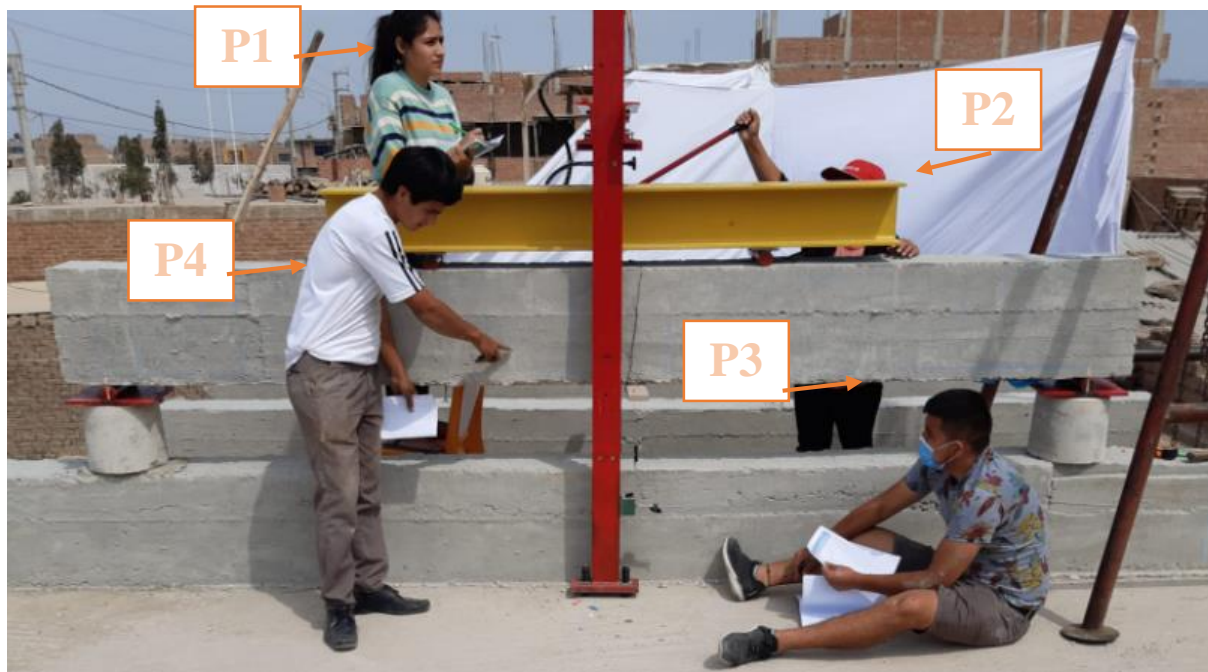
Sistema ensamblado de ensayo a flexión de vigas
